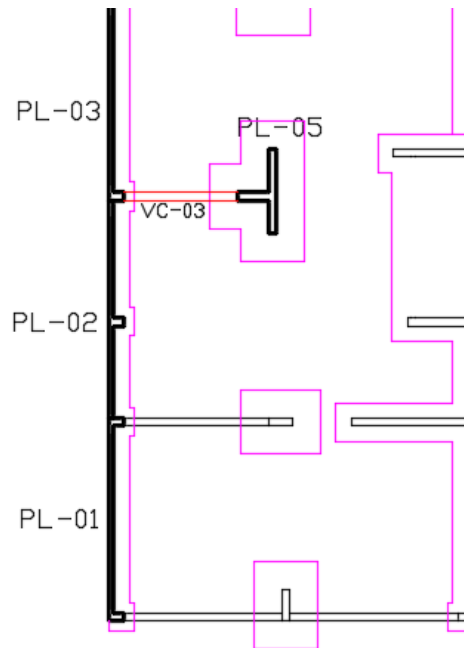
Ubicación en planta de placas PL-01,02,03,05 y viga VC-03.
